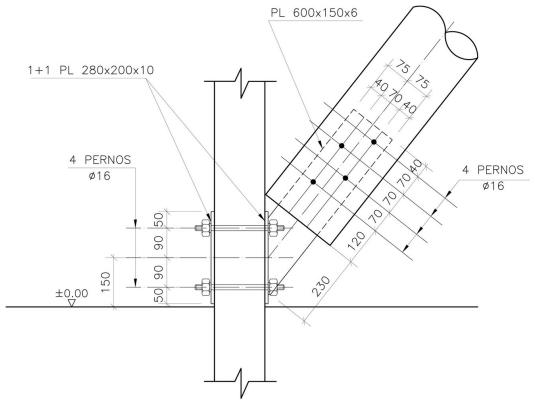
Detalle de la unión Pilar madera al pilar de hormigón, mediante pernos de anclaje. Fuente: Plataforma Arquitectura.
